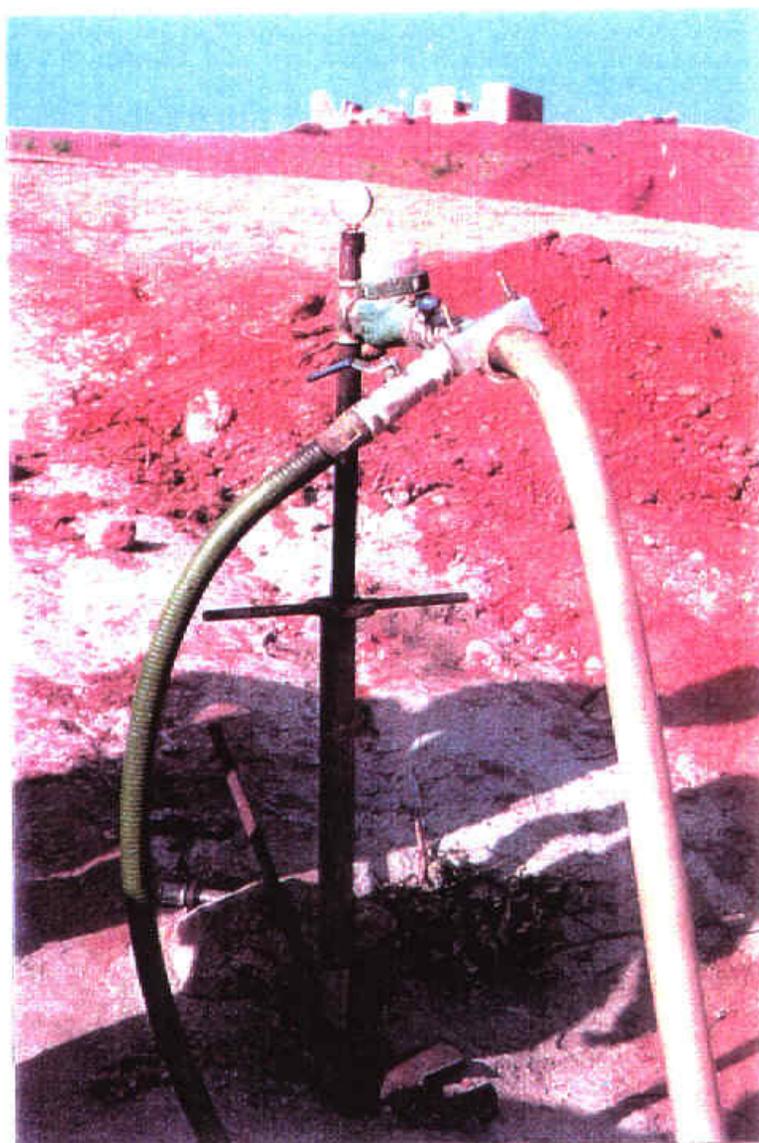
Detalhe do manômetro utilizado nos ensaios de perda d'água (Est. 3).
